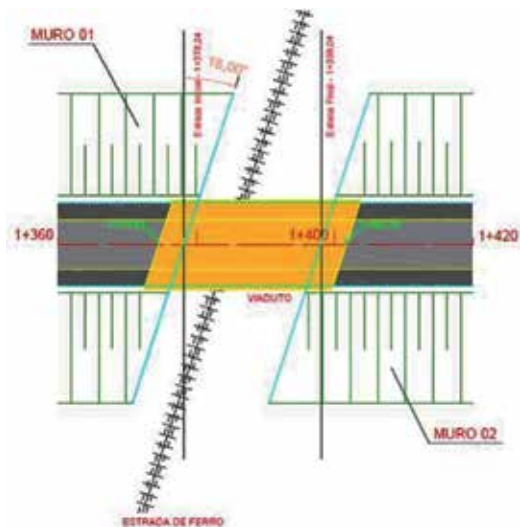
Vista em planta dos muros portantes e da posição do viaduto
